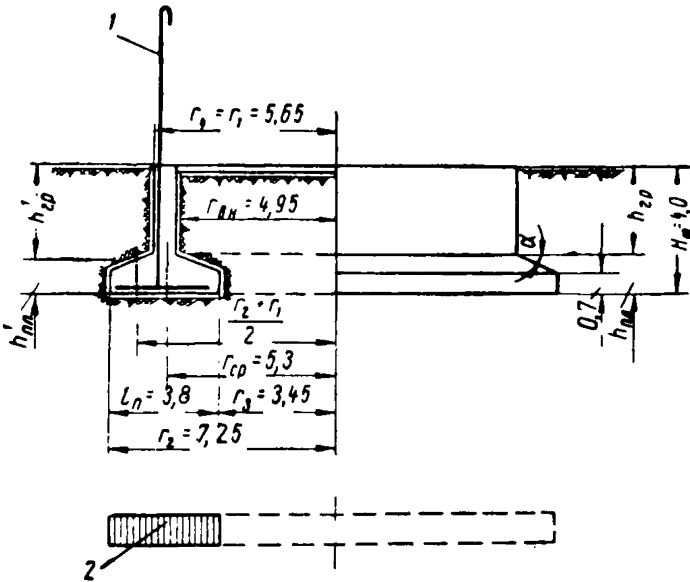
Кольцевой фундамент под трубу (к примеру расчета № 4)
